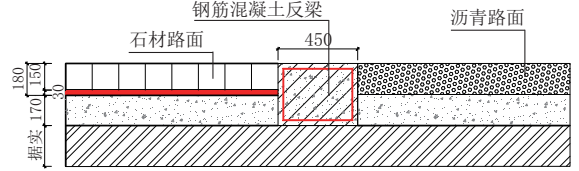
石材与沥青衔接处增设混凝土反梁示意图(单位:mm)
